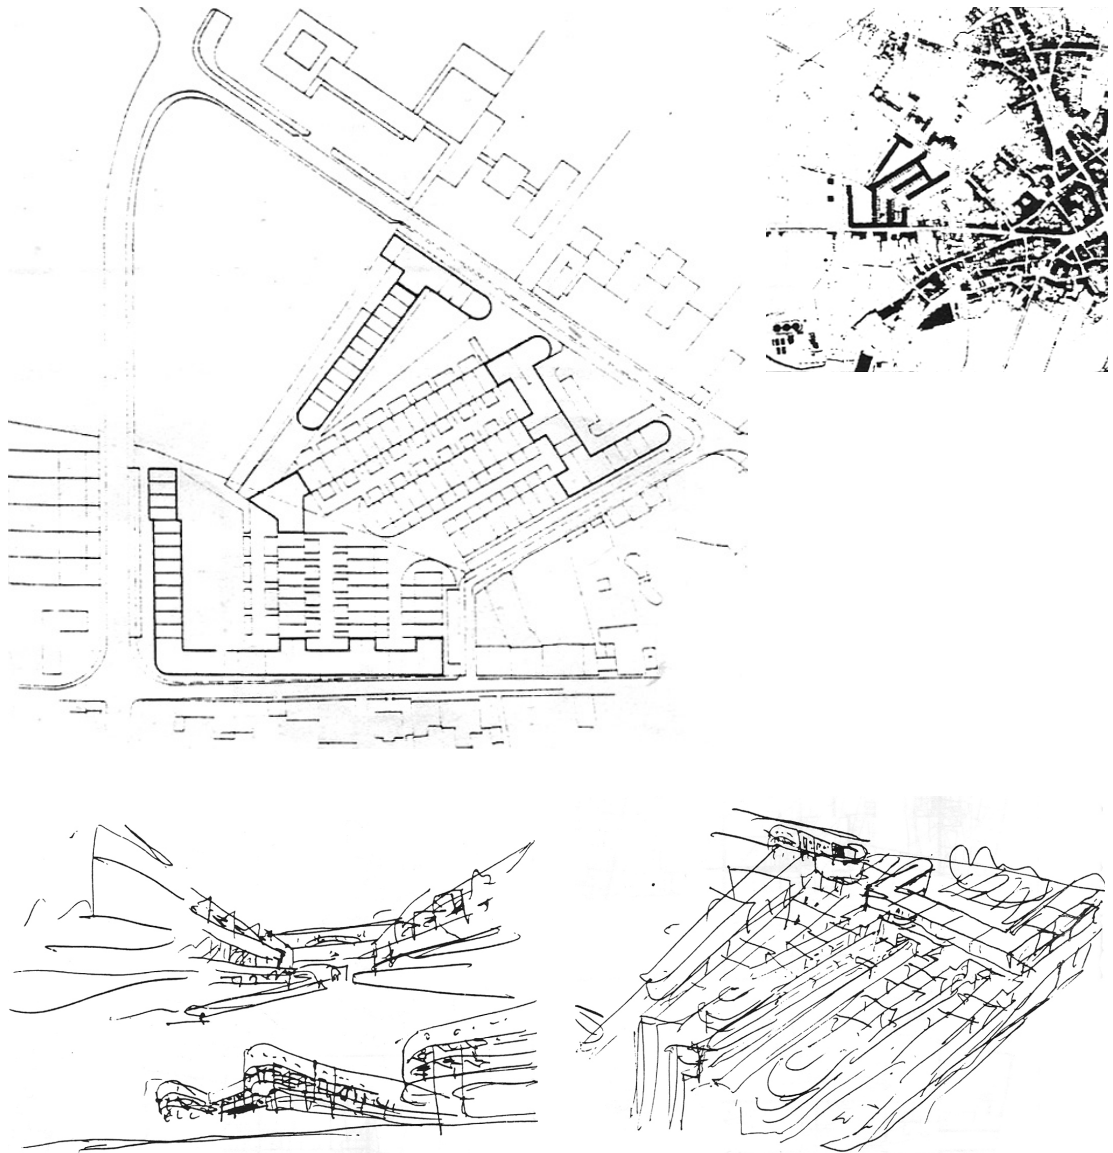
Projecto de Bárbara de Sousa, Ovar, planta geral, implantação e esboços, Álvaro Siza.
